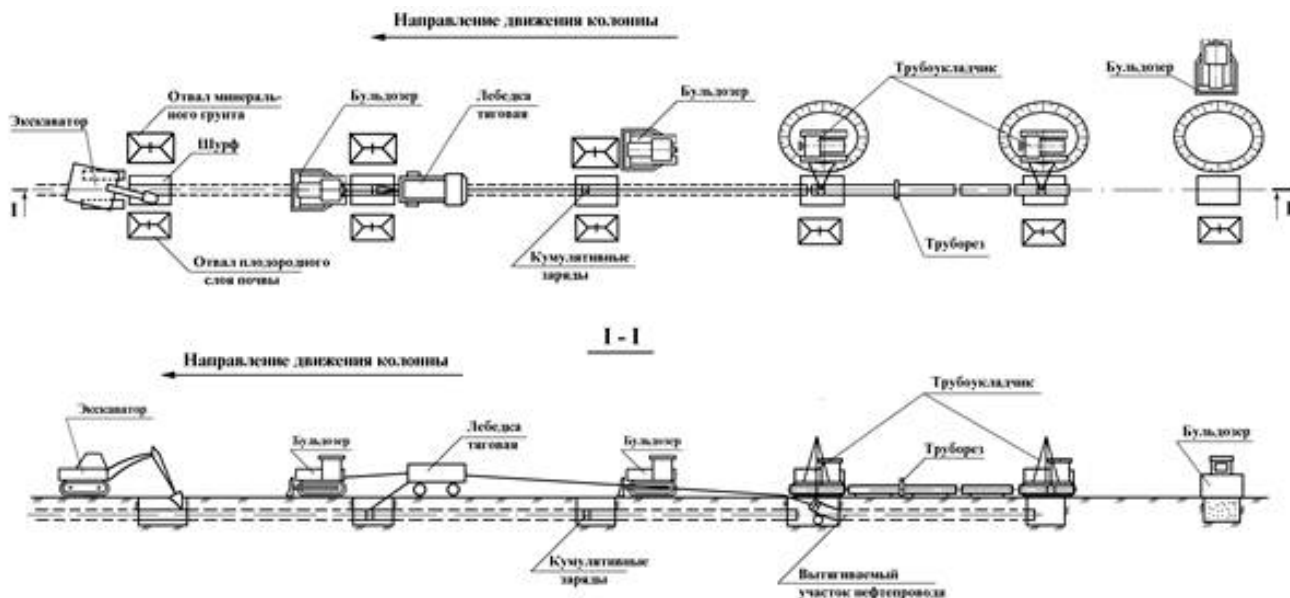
Схема демонтажа с вытягиванием участка трубопровода
